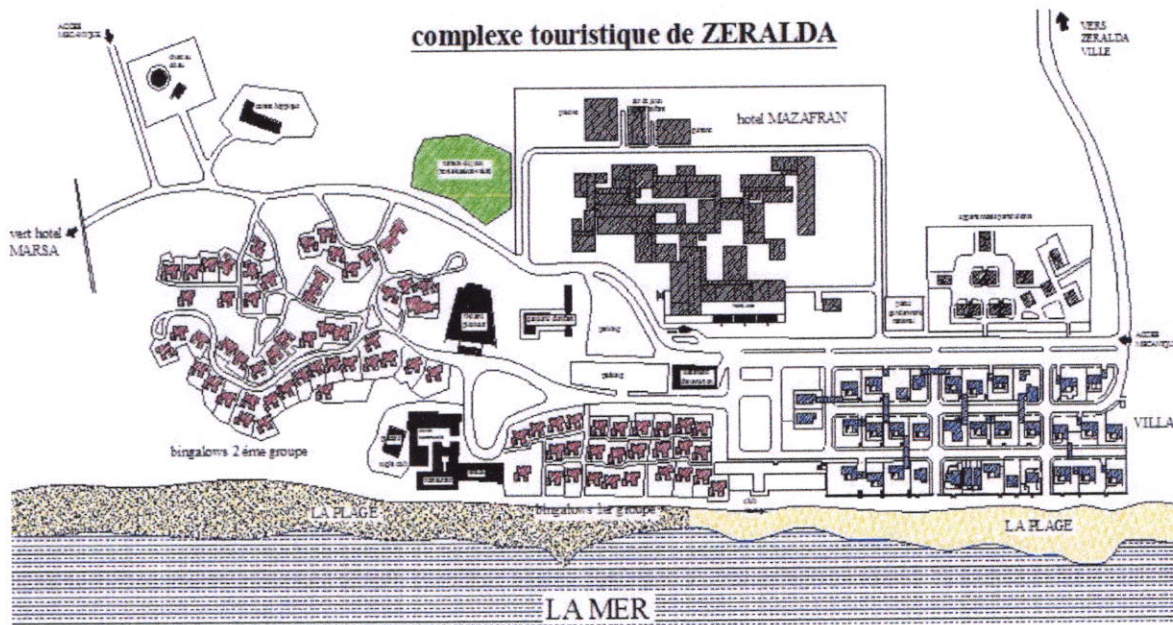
Plan de masse du complexe de Zéralda (source mémoire village touristique balnéaire au andalouse 2014)
